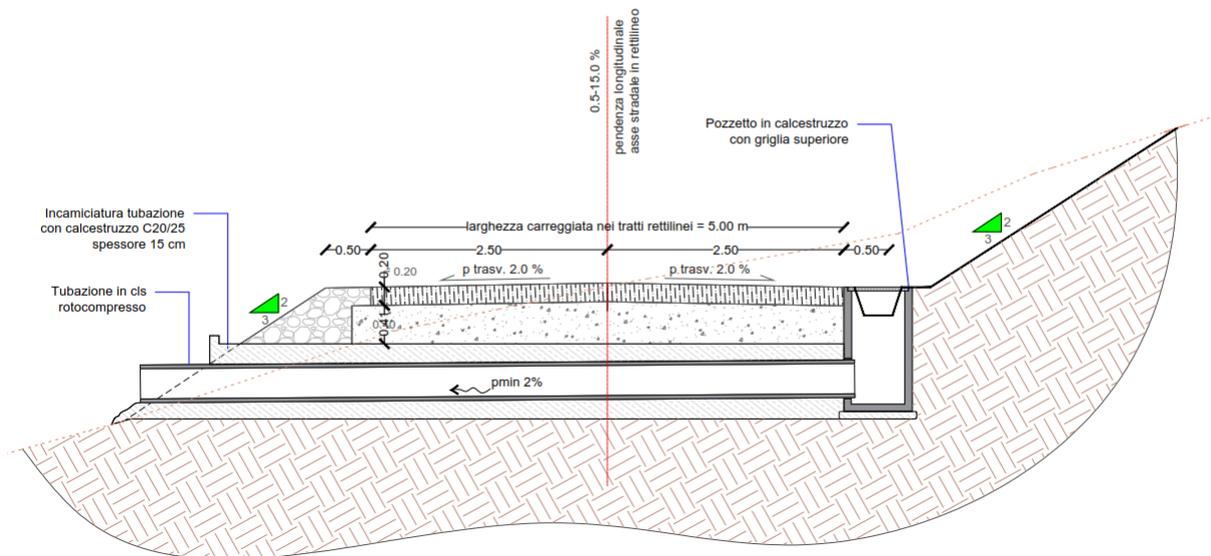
Sezione stradale tipo a mezza costa con pozzetto e tubolare. Fonte: estratto elaborato di progetto “HH0694A-IG-PD-PL-21_SEZIONI STRADALI”
